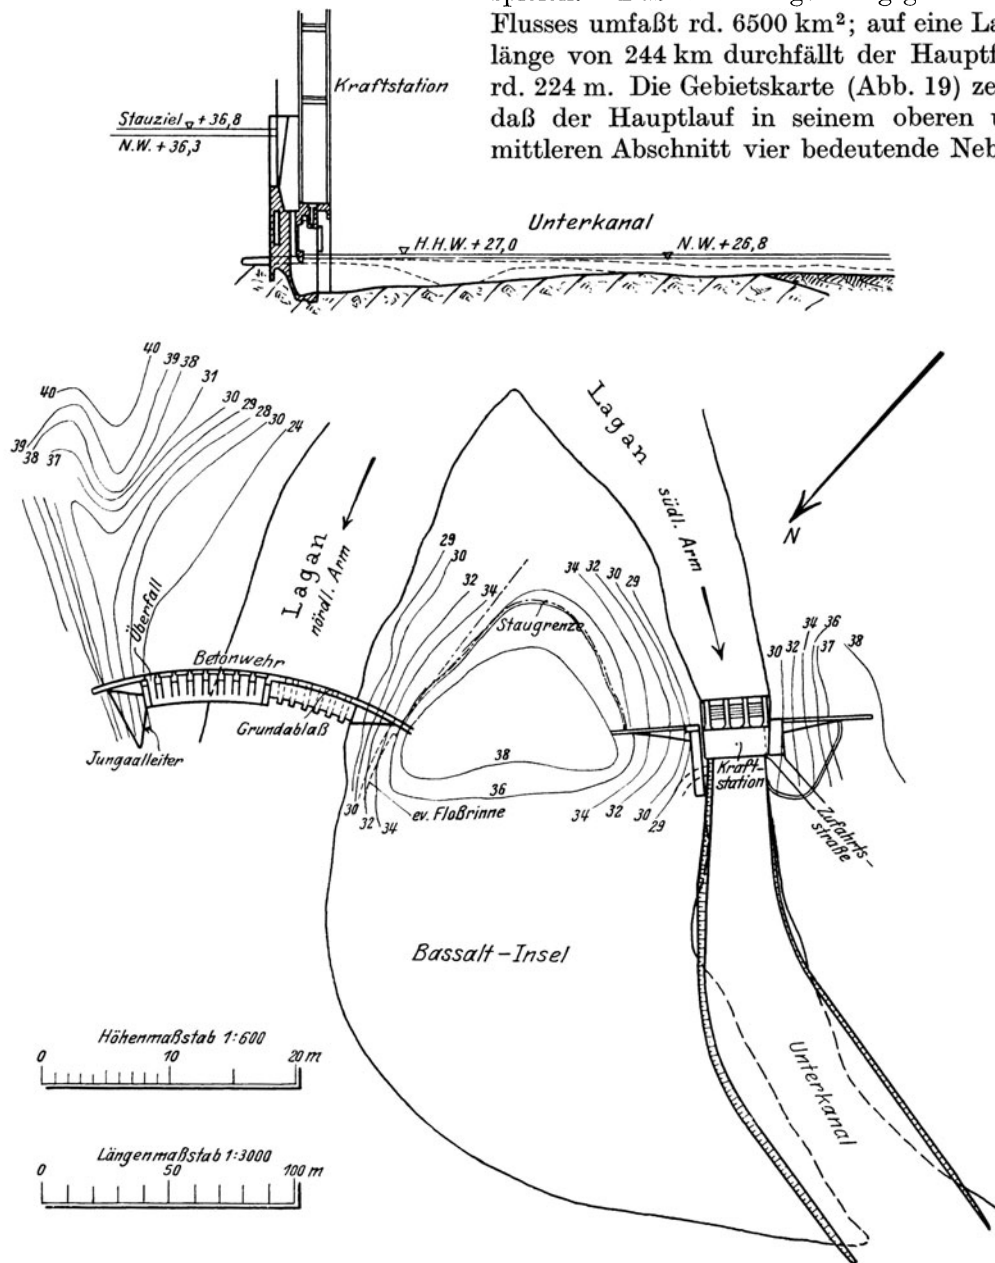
Bassalt. Längenschnitt und Lageplan. (Sv. V. Kr. För. 16.)
